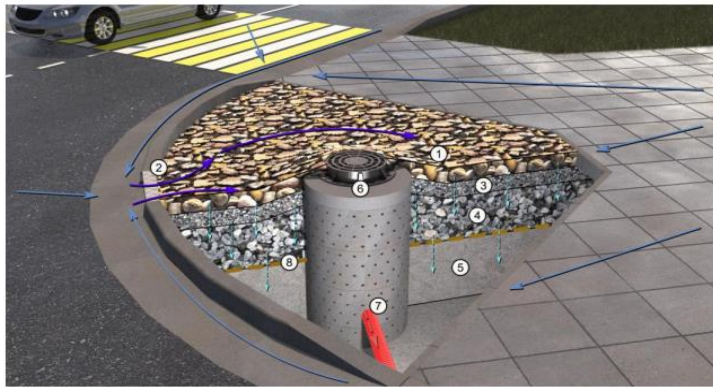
Схема устройства фильтрующих колодцев без предварительной очистки (1 – мощение (верхняя засыпка); 2 – отверстие для стока воды с проезжей части; 3 – основание мощения; 4 – щебень; 5 – песок; 6 – дренажный колодец; 7 – дренажная труба)
